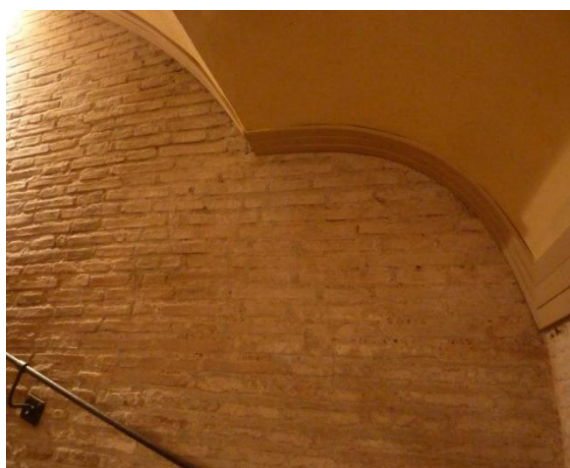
Prospetto SN4e, particolare copertura. Foto D'Ippolito.
